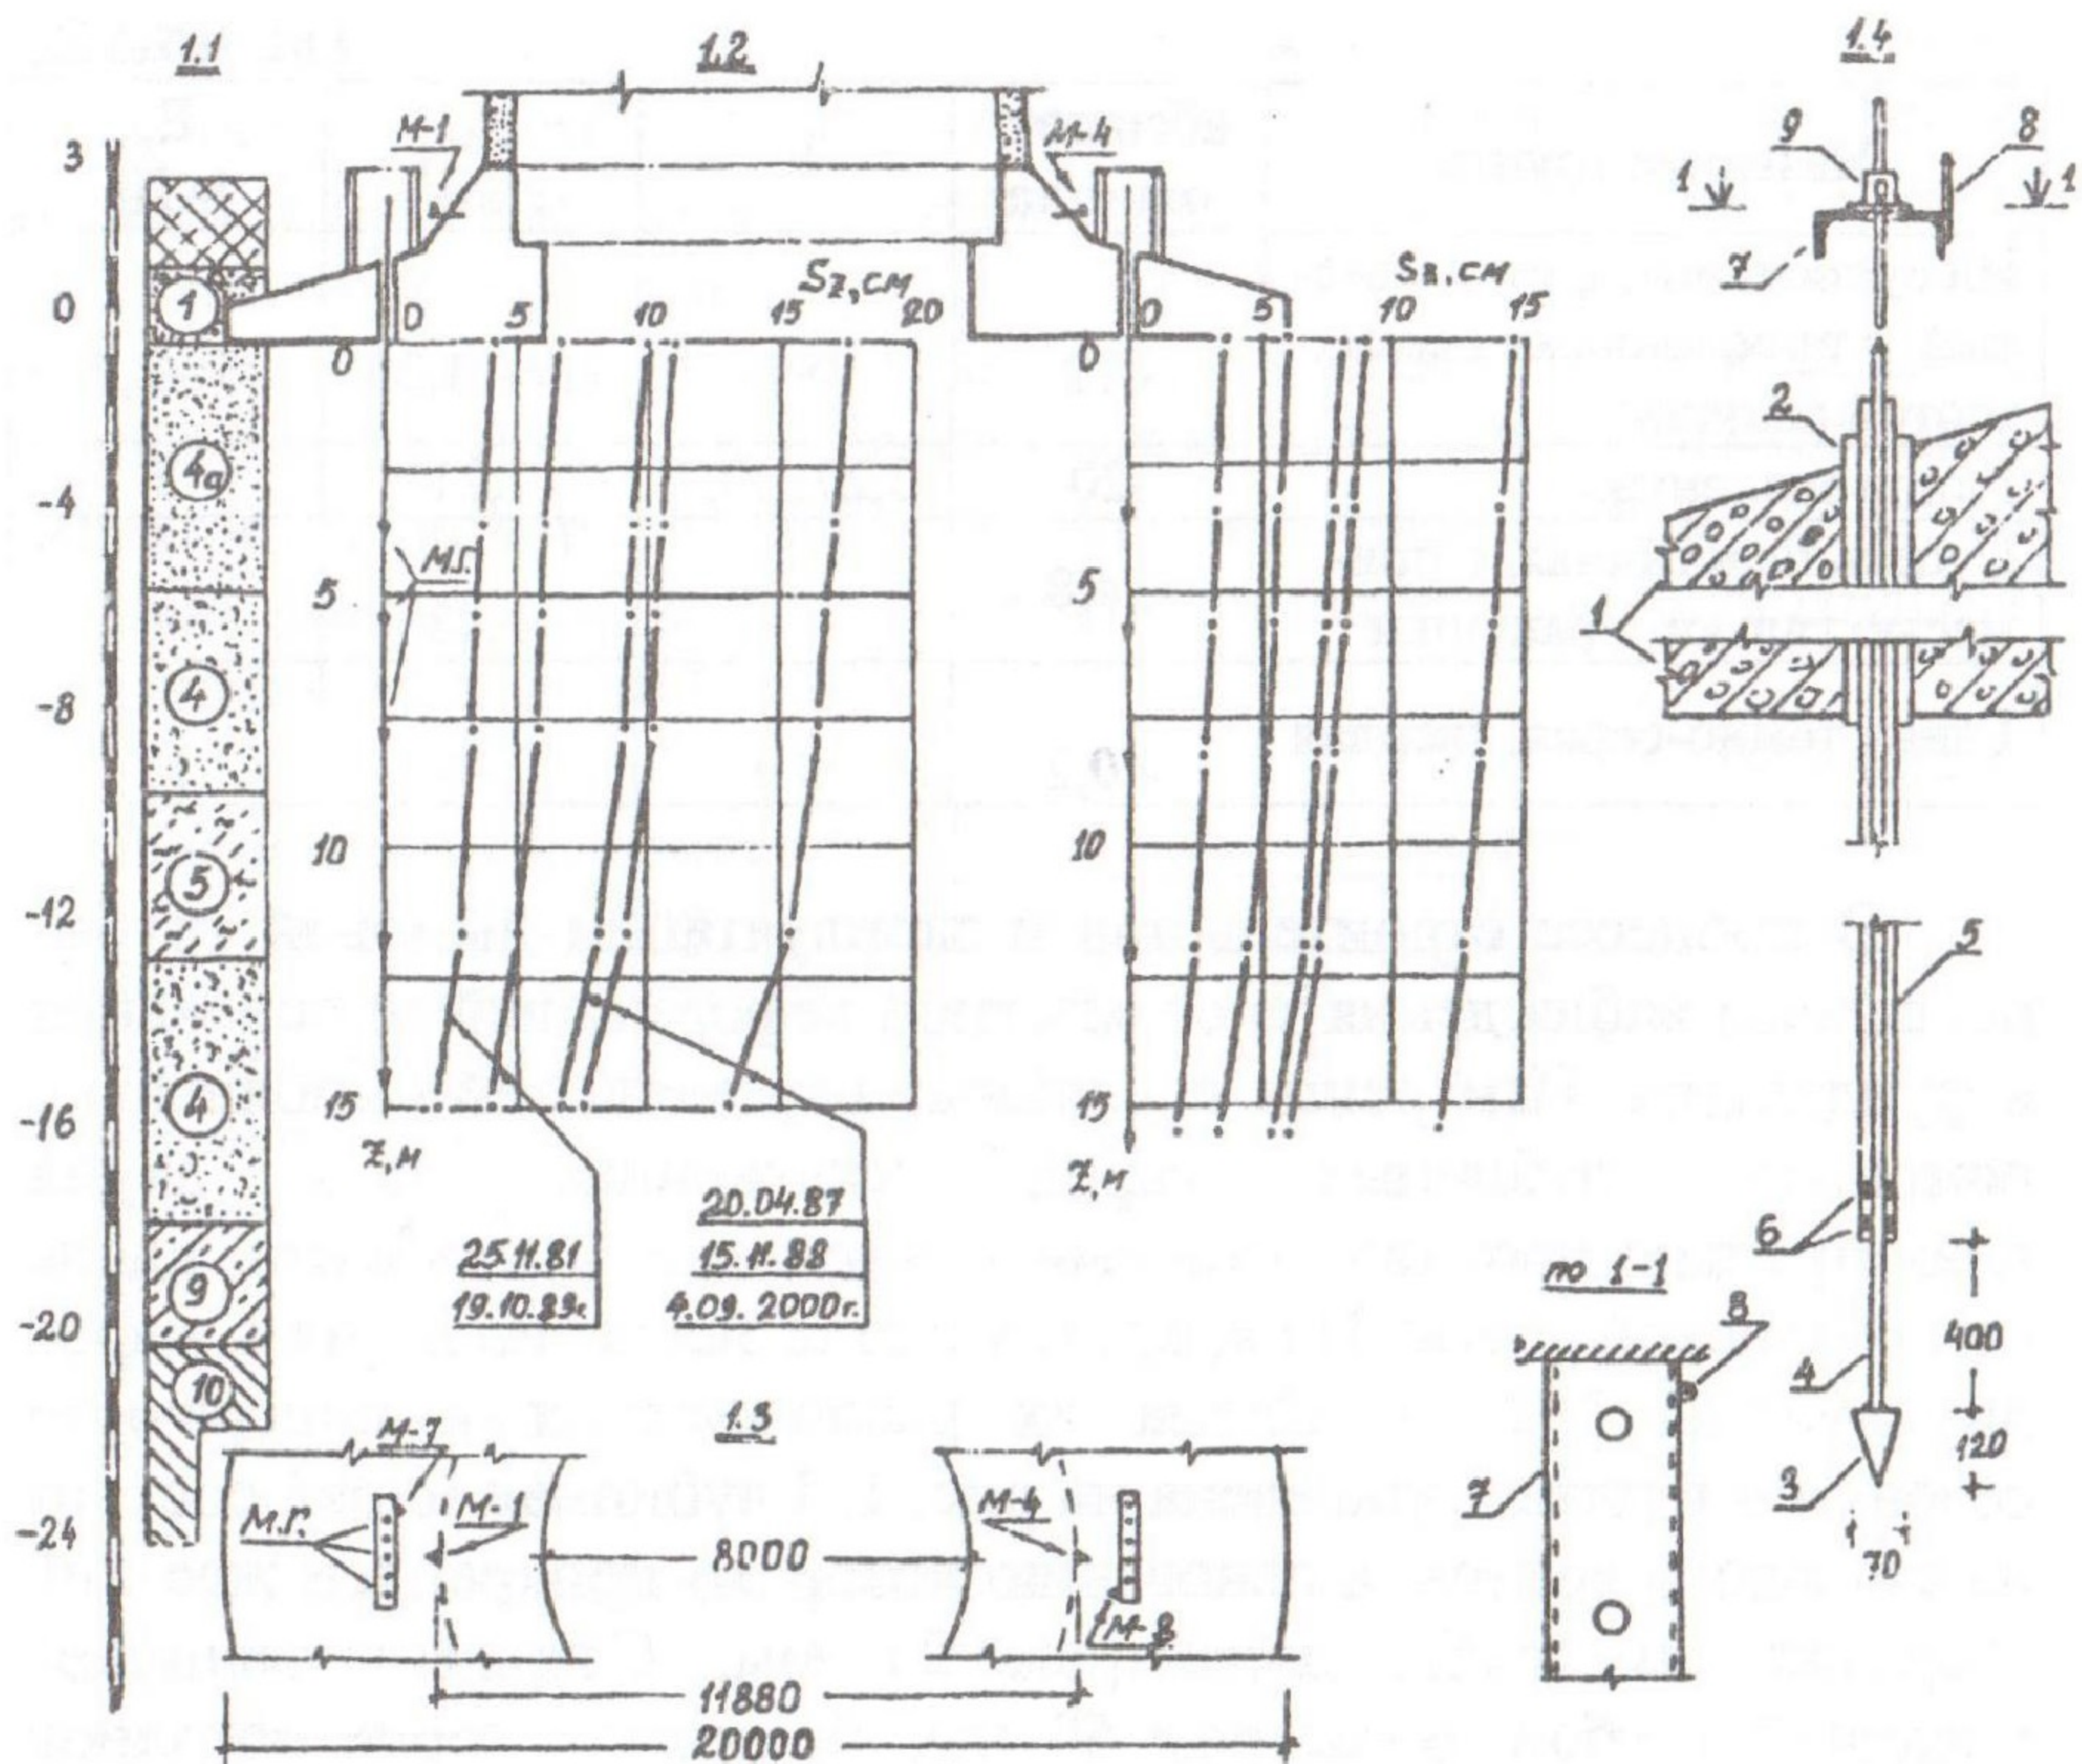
Схема расположения глубинных марок, их конструкция и эпюры послойных перемещений. 1.1. Геологическое строение основания. 1.2. Поперечное сечение фундамента. Схема расположения глубинных марок. Эпюры послойных перемещений. 1.3. Фрагмент плана фундамента со схемой размещения глубинных (М.Г.) и стенных (М) марок. 1.4. Конструкция глубинной марки: 1 – фундамент; 2 – «гильза» – отрезок трубы для устройства вертикального отверстия в теле фундамента; 3 – глубинная марка; 4 – стержень, идущий от марки к поверхности; 5 – обсадная труба для защиты стержня от контакта с окружающим грунтом; 6 – сальники между стержнем и обсадной трубой; 7 – реперная балка, соединенная с фундаментом; 8 – марка на реперной балке для измерений её перемещения геометрическим нивелированием; 9 – штангенглубиномер для измерения перемещений глубинных марок.
